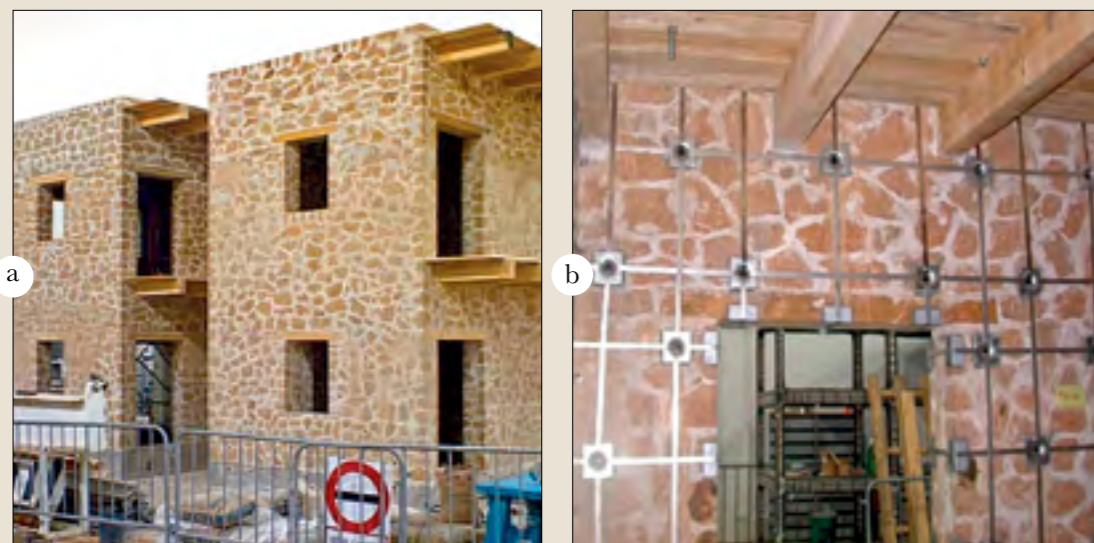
Progetto TREMA: a) Struttura dell'edificio di prova; b) Struttura rinforzata con il sistema di confinamento attivo della Muratura.
